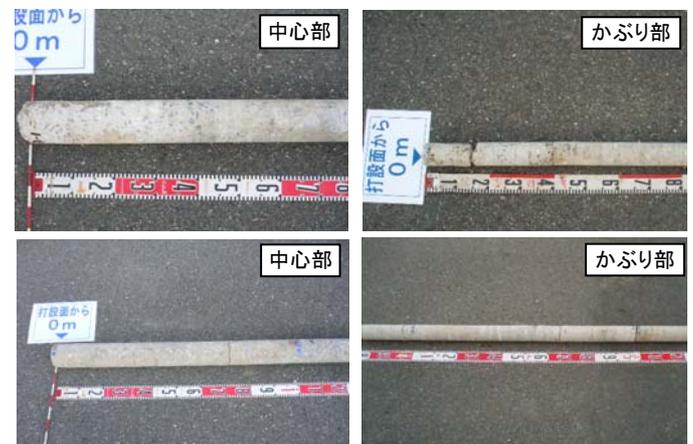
採取したコアの外観(上:No.1, 下:No.2)
